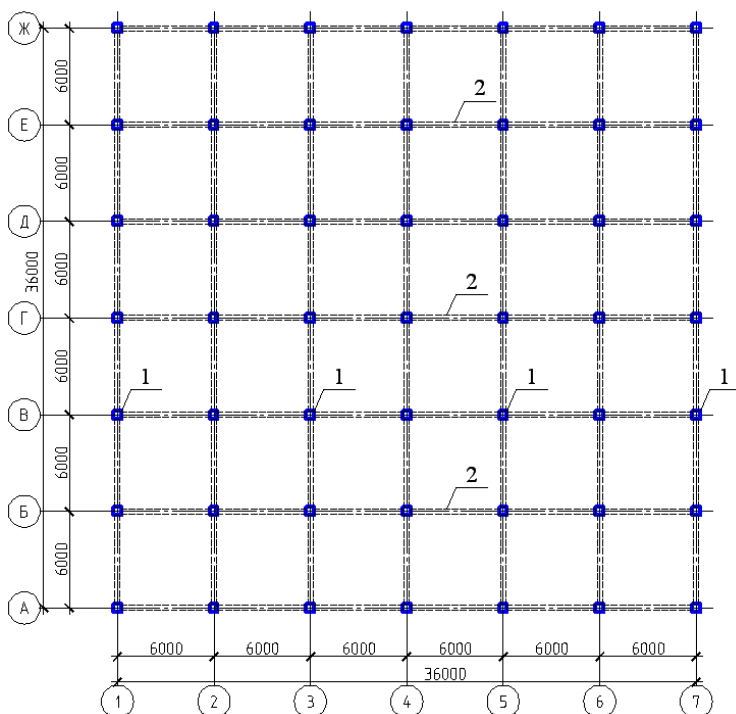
План типового этажа, 1 – колонны, 2 – ригели
